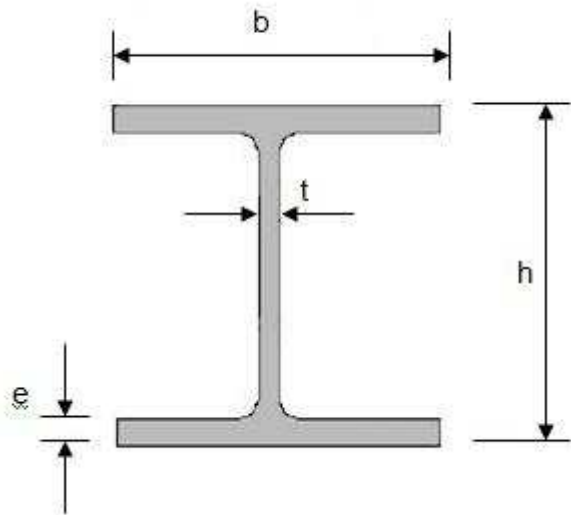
Geometria de perfis metálicos laminados do tipo “H”
